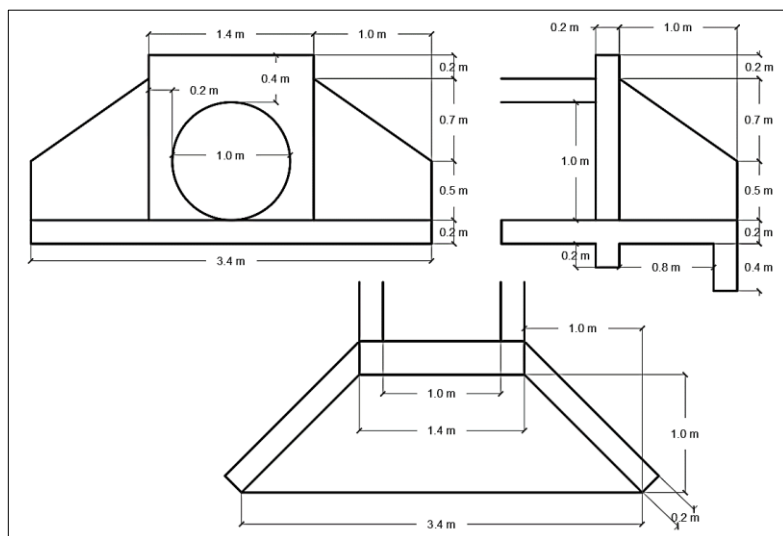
Dimensiones de alcantarilla tipo cajón
